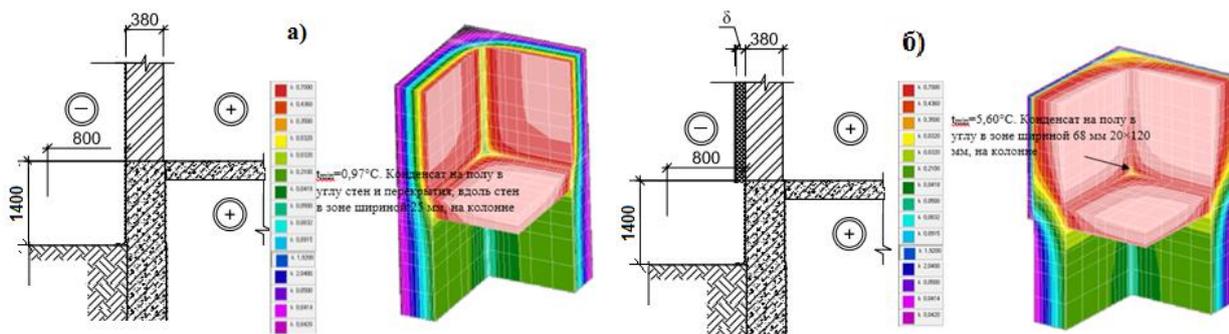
Конструктивное решение узла примыкания наружной стены к грунту и его температурное поле: а – с неутепленной стеной; б – с утепленной стеной.
